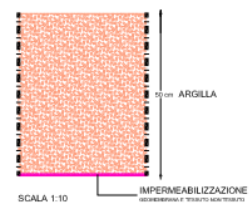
Stralcio della tavola T04 "Planimetria sistemazione Piano di appoggio degli impianti e pavimentazioni del P.D.C. 1° stralcio "Intervento di realizzazione del nuovo impianto di lavorazione dei materiali lapidei frantoio San Cesario all'interno del Polo estrattivo n. 9 Via Graziosi"(sopra) - scala grafica.
